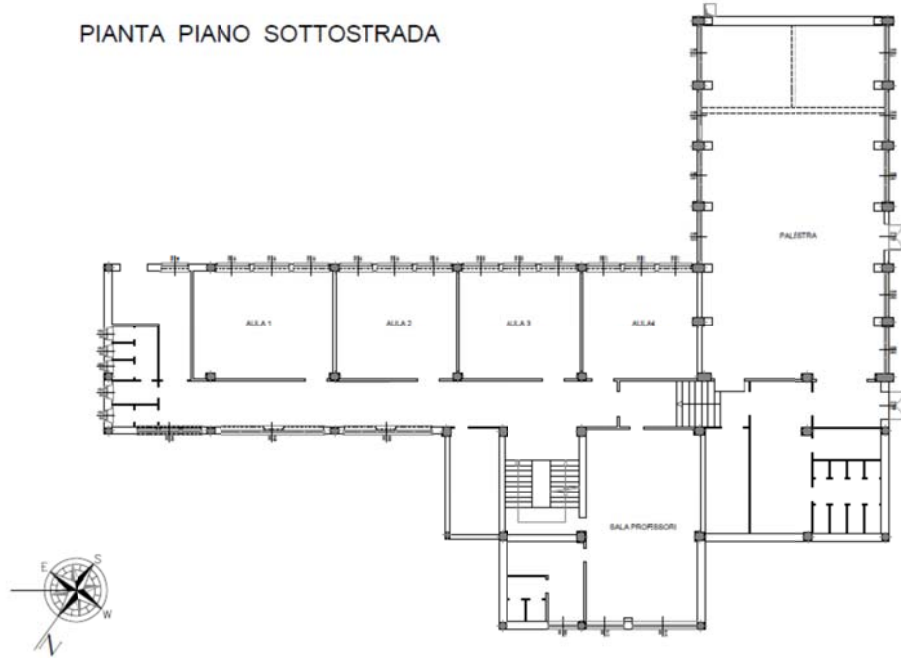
Edificio 2 - Pianta piano sottostrada.
